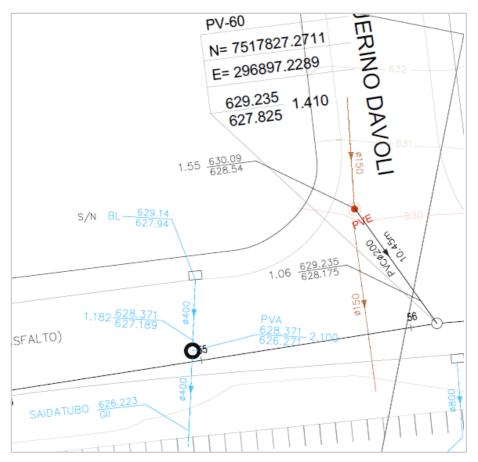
Asbuilt CT ST Antonio MD R01 - Rebaixamento de Galeria DN 400mm - PV59 ao PV60, trecho compreendido entre as ruas José Bizigatto e Rua Guerino Davoli.
